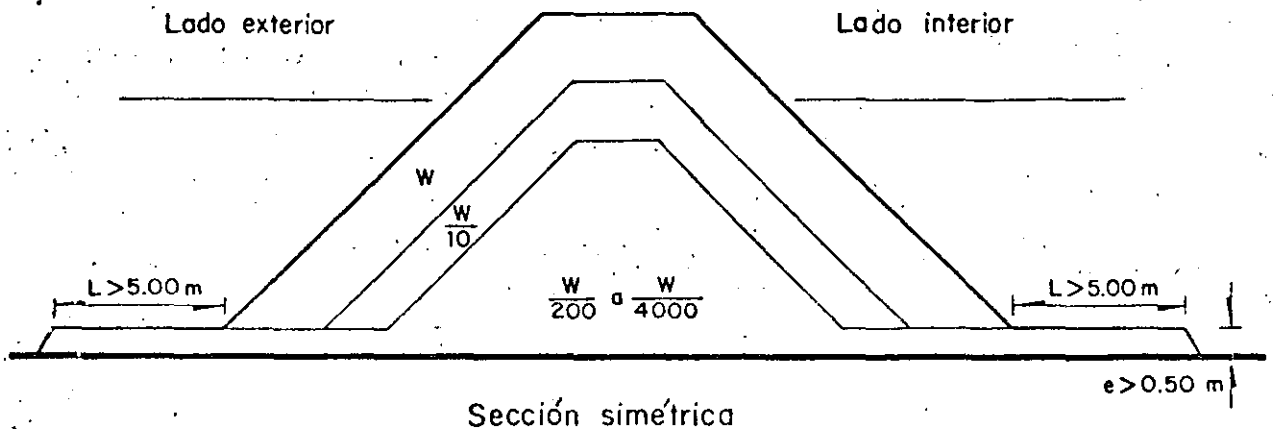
Sección transversal para el morro de una escollera formada con enrocamiento
